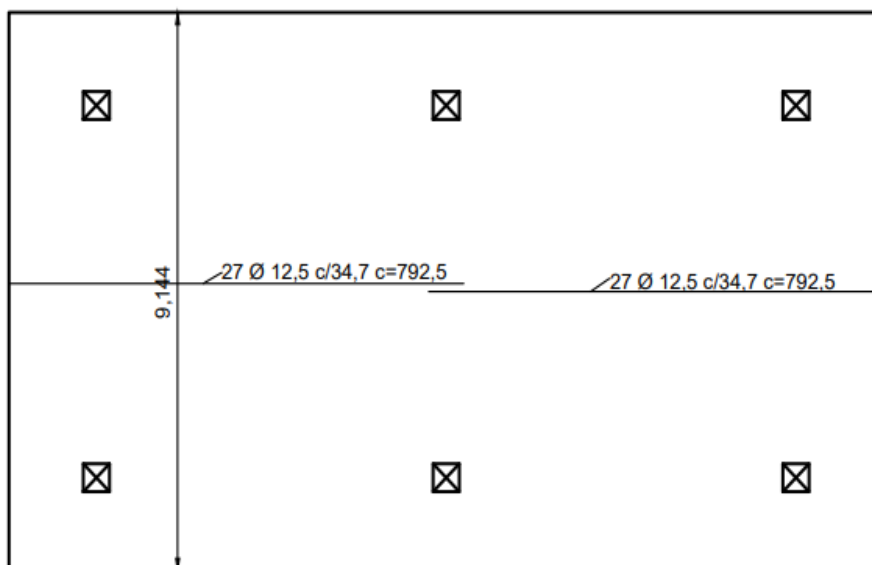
Armadura longitudinal Inferior. Adaptado de Fick (2008).
